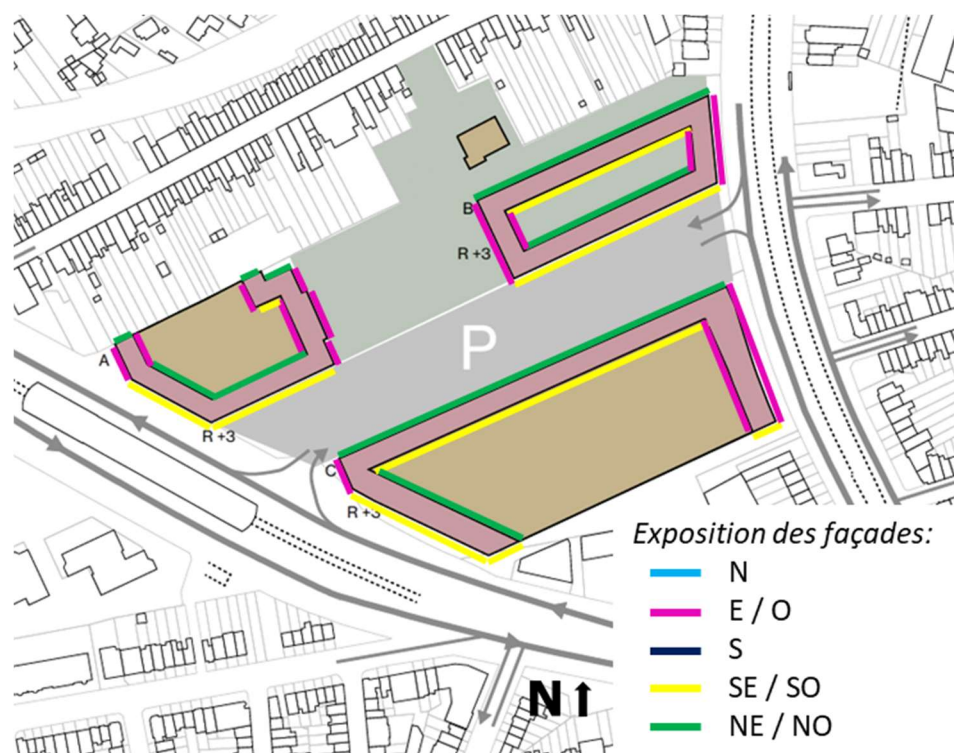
Orientation des façades des bâtiments du site Demey – alternative 0 (ARIES, 2018)
